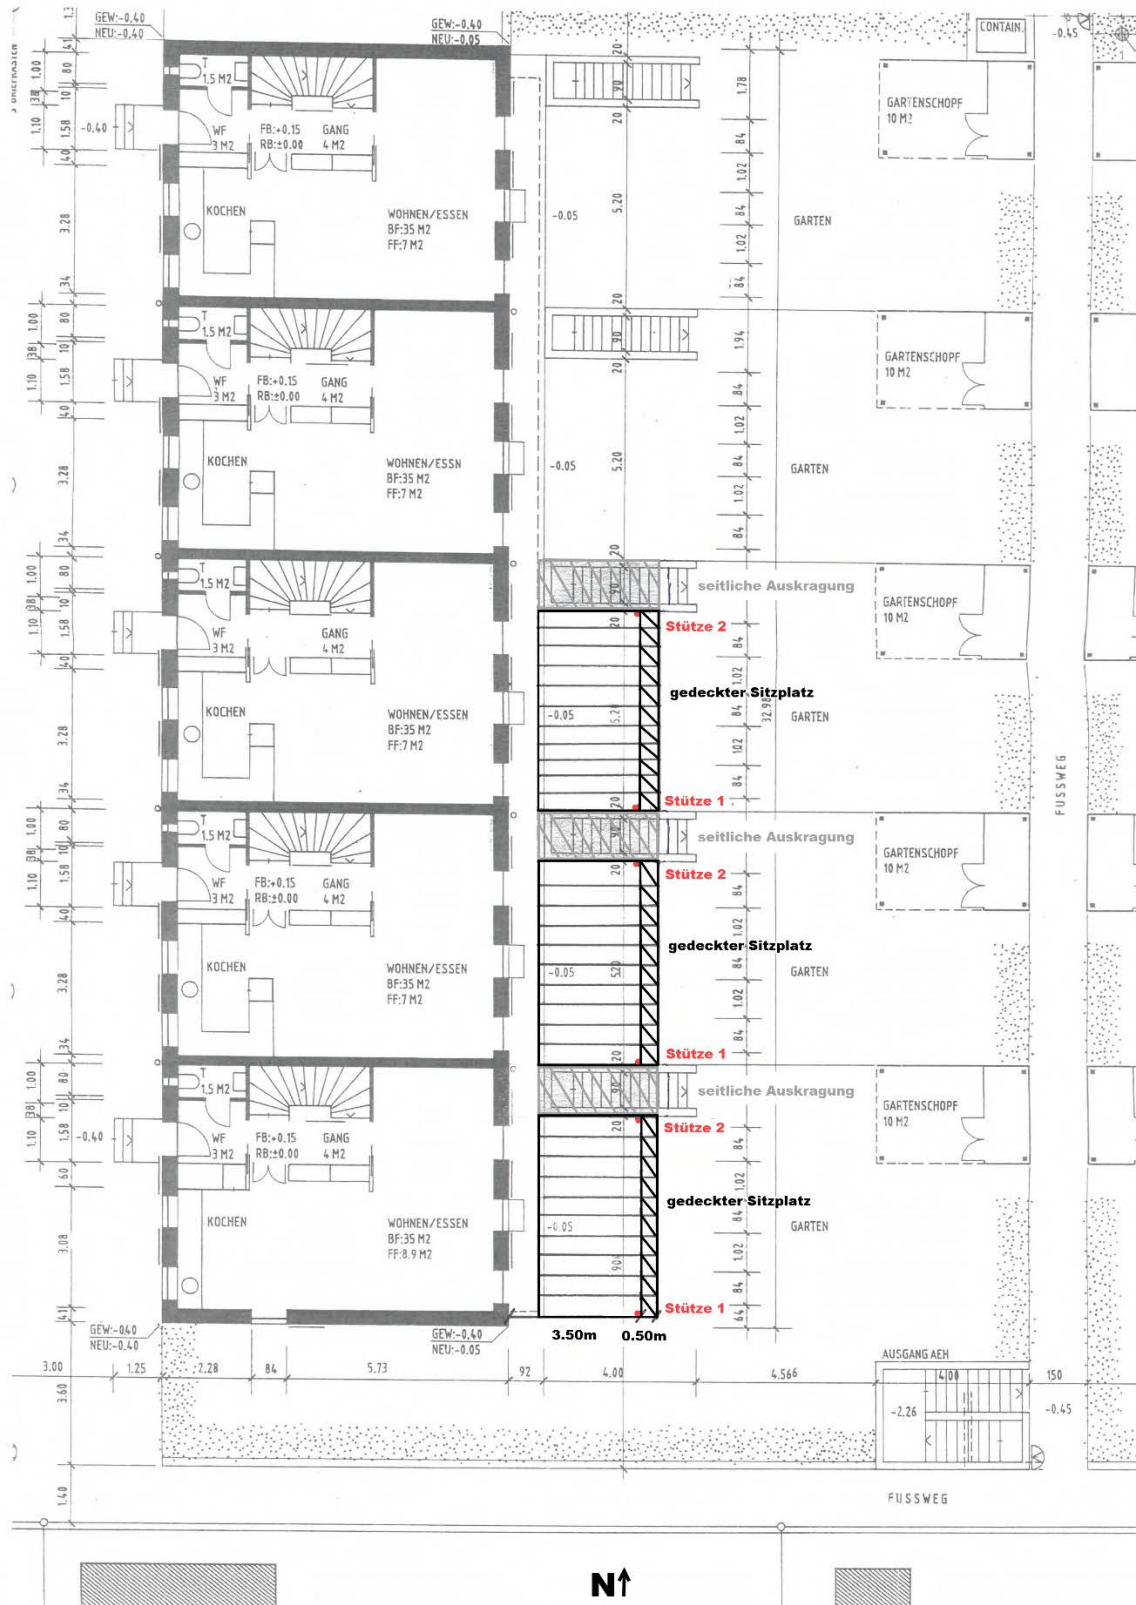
Grundrissplan für gedeckte Sitzplätze
